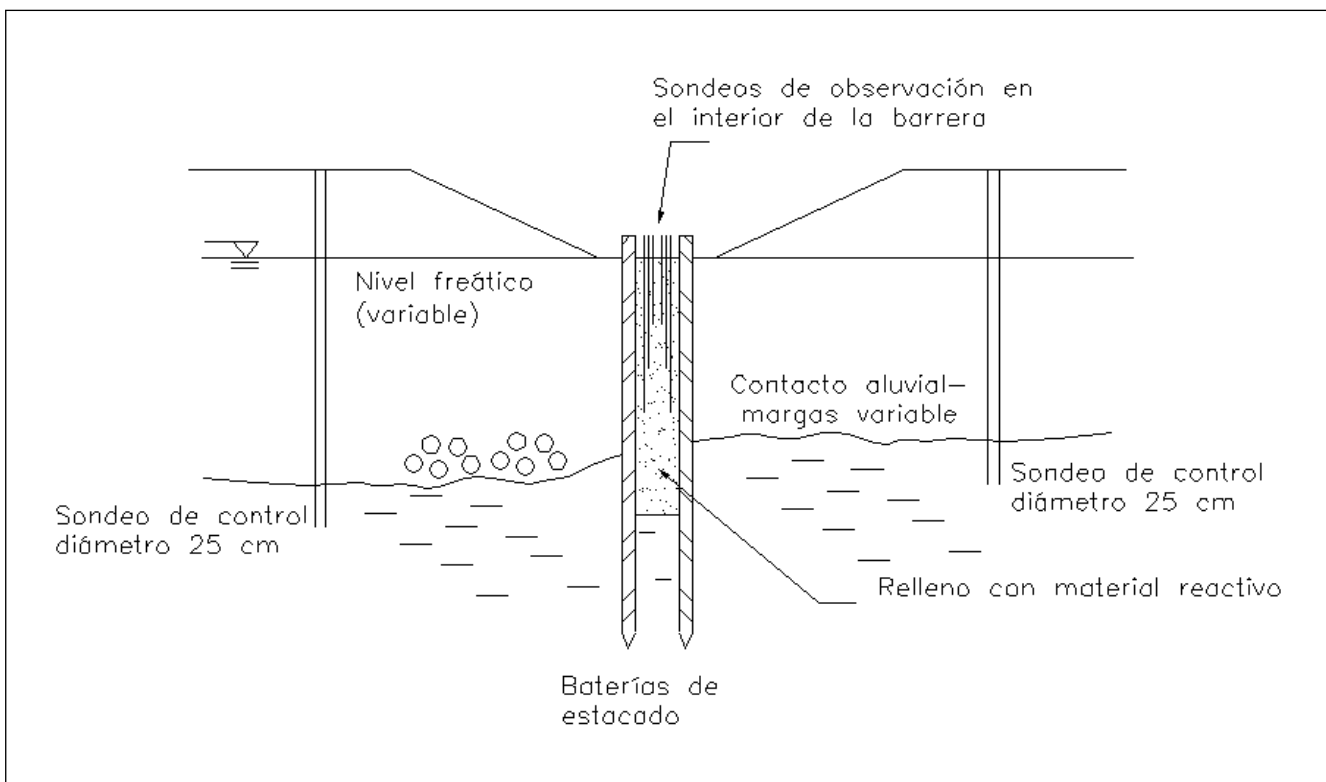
Sistema de construcción de la barrera por estacado. El sistema de tablestacas es análogo, sustituyendo los rollizos por planchas metálicas (tablestacas). En ambos casos, se hincan primero las estacas, que forman un recinto protegido. Este se excava y se rellena con el material reactivo. Posteriormente se retiran las estacas.
